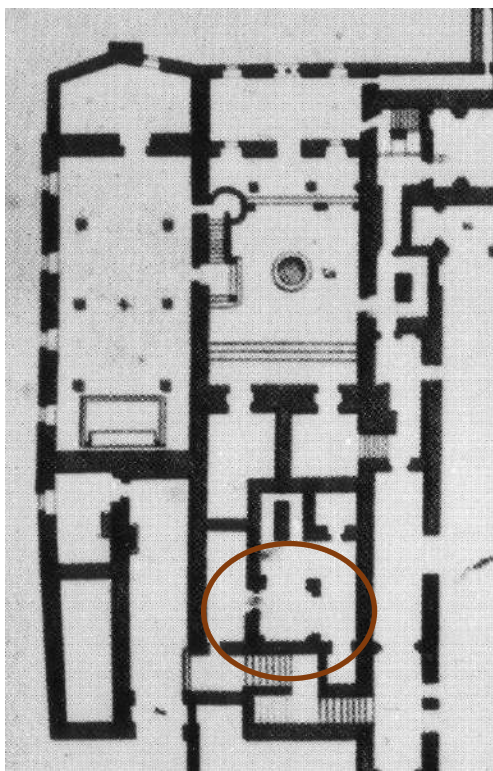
Planta del Mexuar indicando la situación del patio trasero a la fachada de Comares. Detalle del plano de Alexandre Laborde, 1812.
